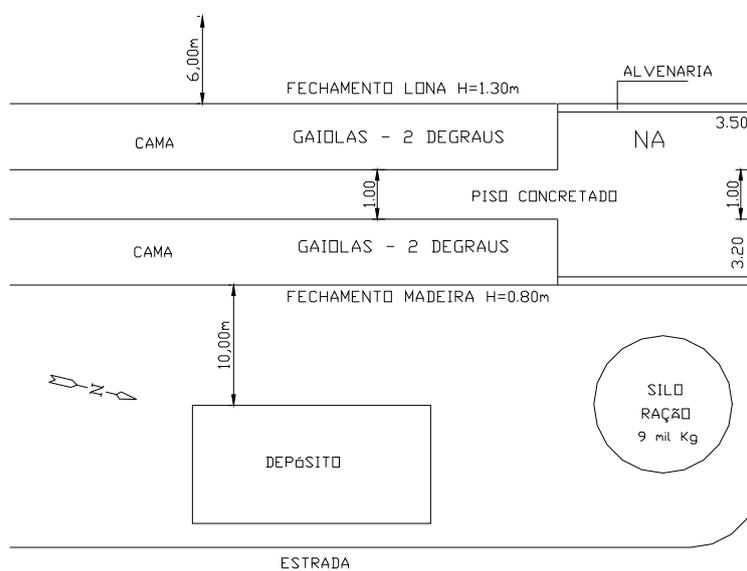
Planta esquemática do galpão natural acondicionado (NA)
